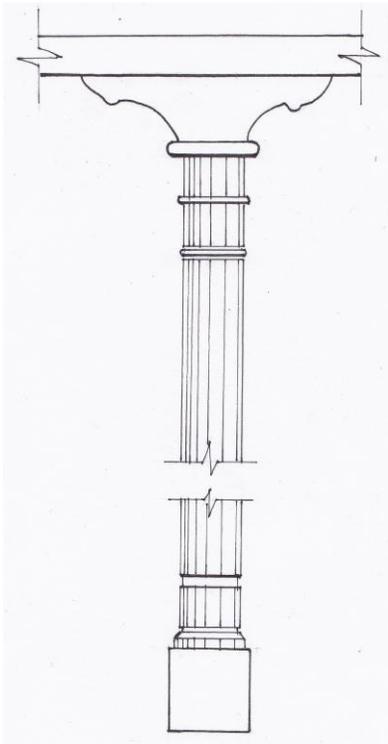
Detalle de columna. ELABORÓ: Mauricio Sosa
